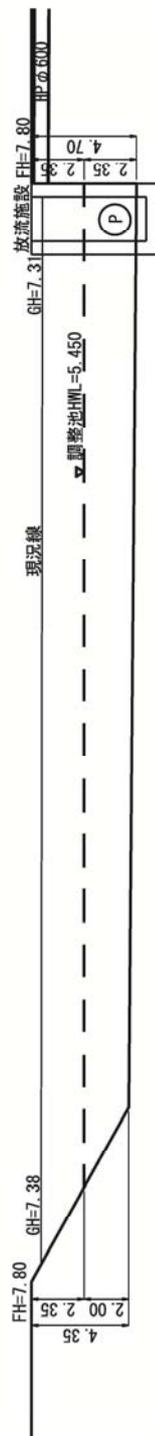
(1) 調整池計画平面・断面図 (第2調整池) 【変更前：評価書】
